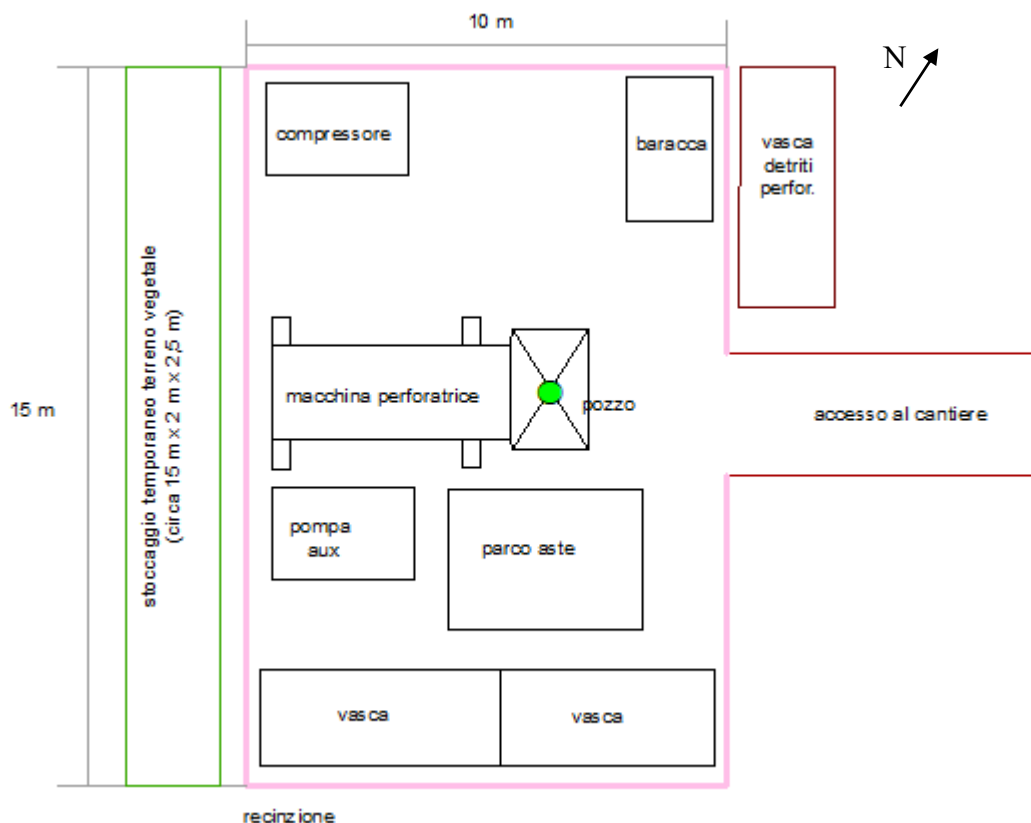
Layout di cantiere del pozzo 1 con i principali equipments (estratto da Allegato 1 – quadrante b))
